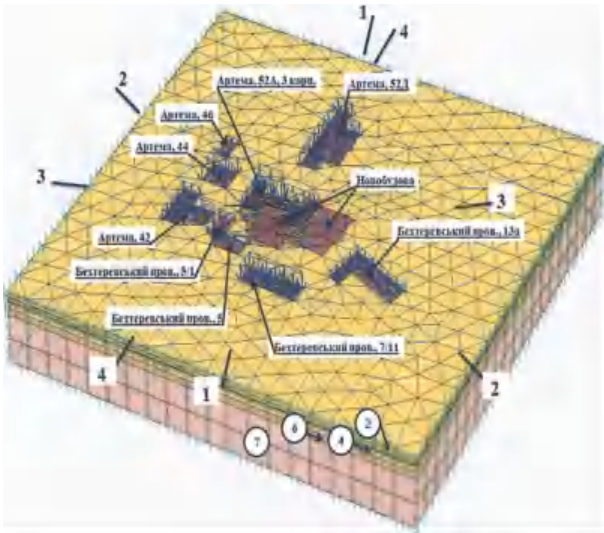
Візуалізація напружено-деформованого стану системи «грунтова основа – фундамент оточуючої забудови – новобудова» / Scheme to calculate the stress-strain state of the system «Soil foundation – the foundation of the surrounding building - a new building»
